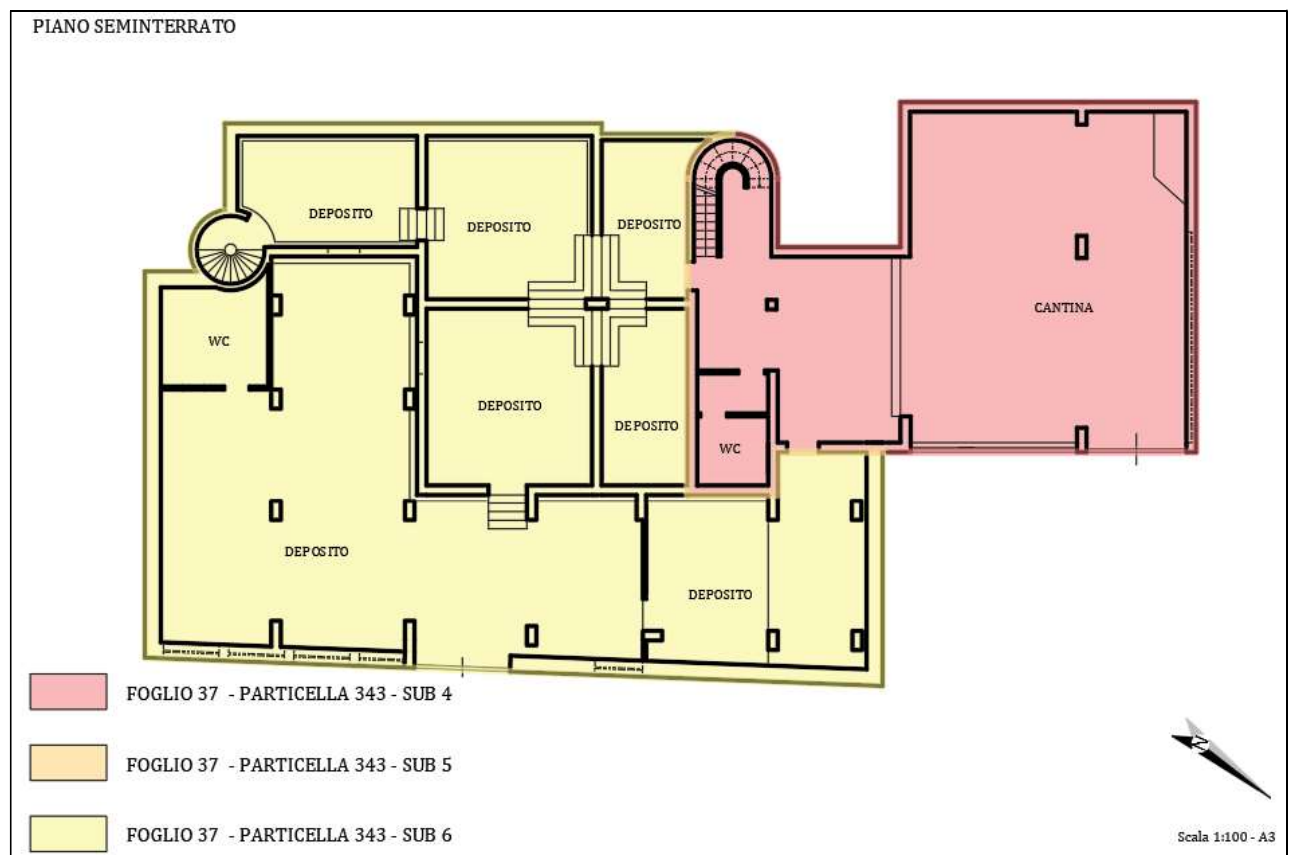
Planimetria dell'immobile – Piano seminterrato
